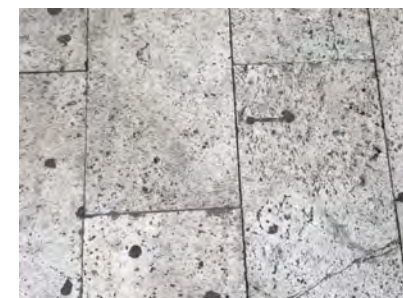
Pavimento de zonas de calle Muro de Santa Ana y circundante a las Torres de Serranos. Adecuado aunque algo resbaladizo en mojado
